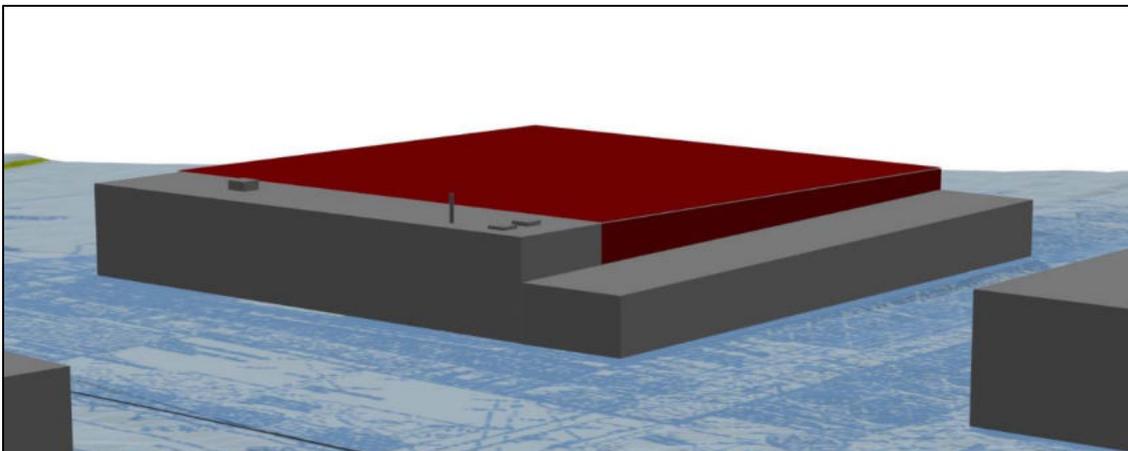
3D-Darstellung der geplanten Zweifachsporthalle, Blick nach Nordwesten
